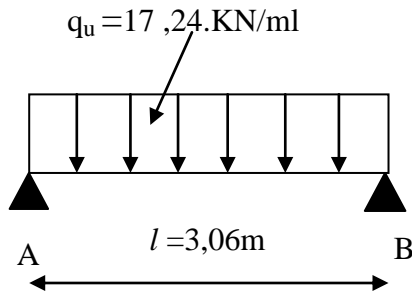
schéma statique de la poutre de chaînage à l'ELU.
